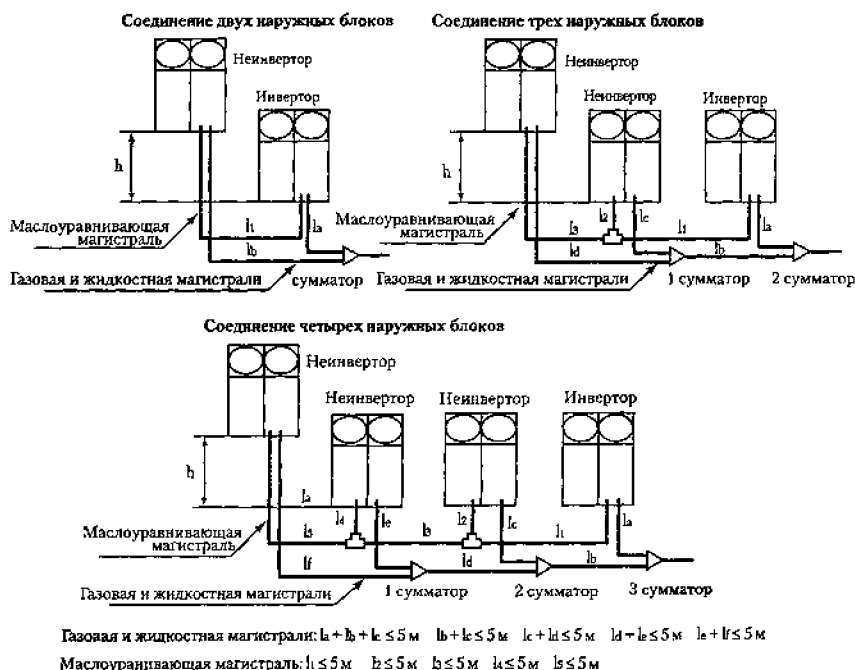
Возможные схемы соединений наружных блоков
